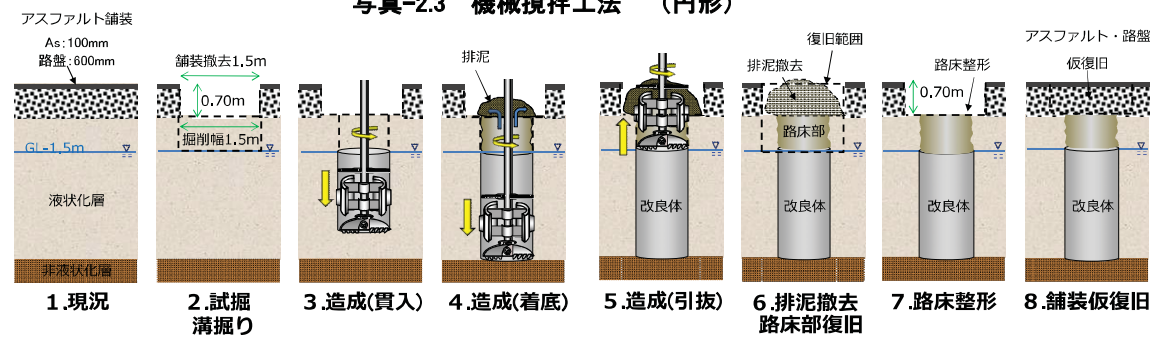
機械攪拌工法の施工手順 (道路部を標準)
